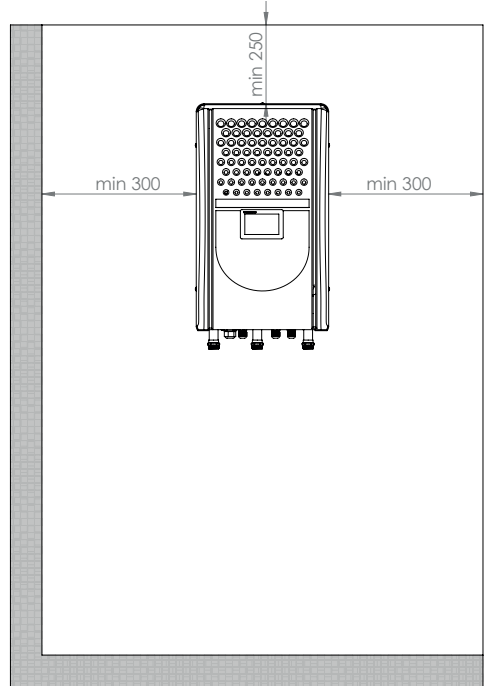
Montageabstände für das Hydraulikmodul Gbox
